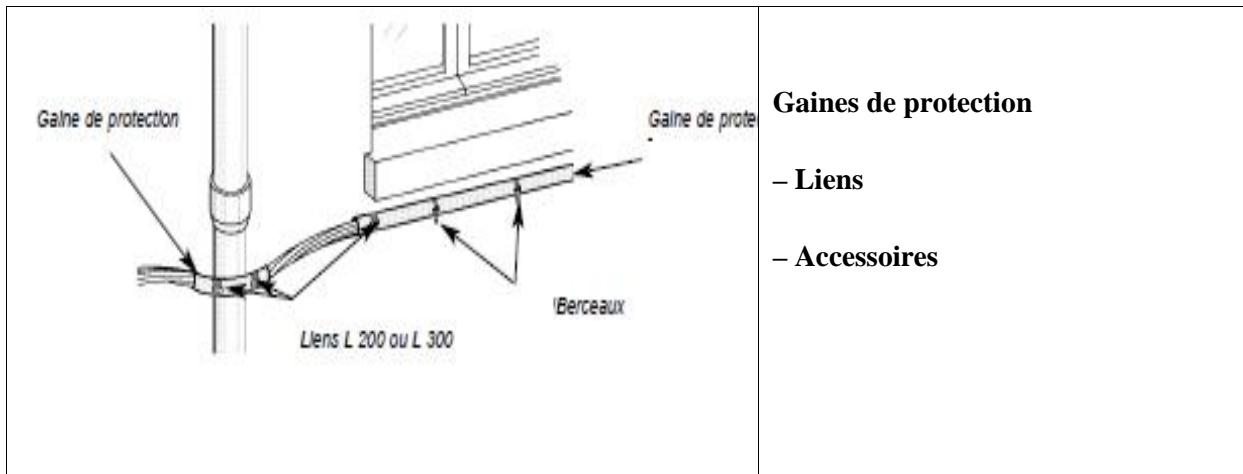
Les éléments de fixation des câbles torsadés sur façade.
